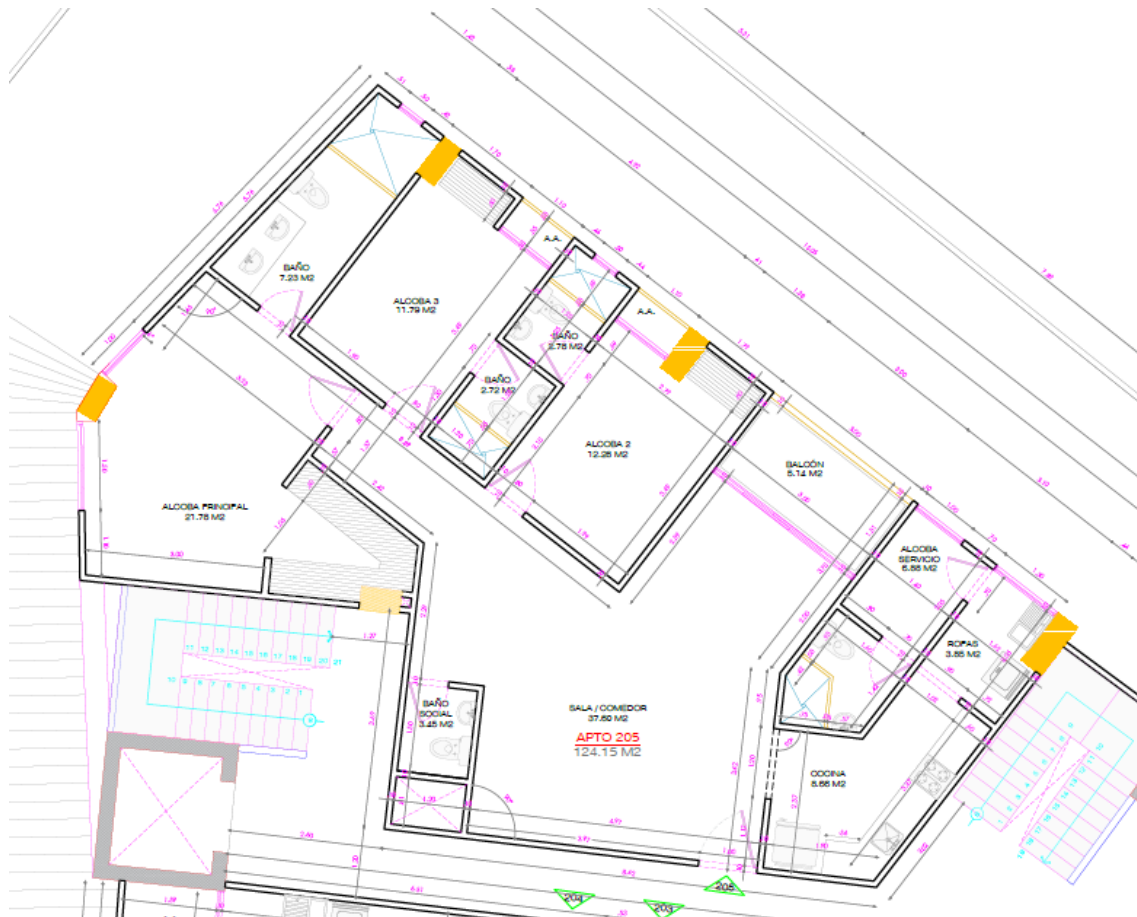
Planta arquitectónica apartamento tipo 5 (Pedrozo Perez)
